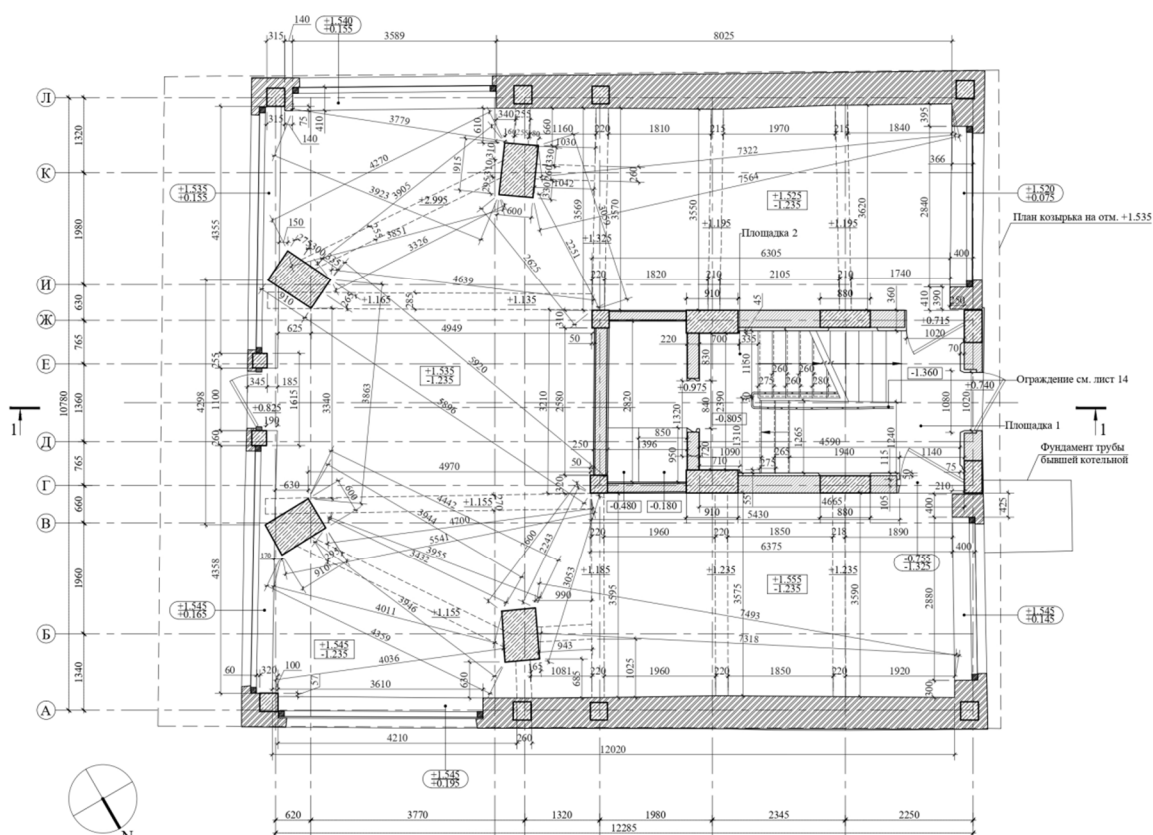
План на отм. -1.235. Источник: <https://tower1929.ru/restoration>.
